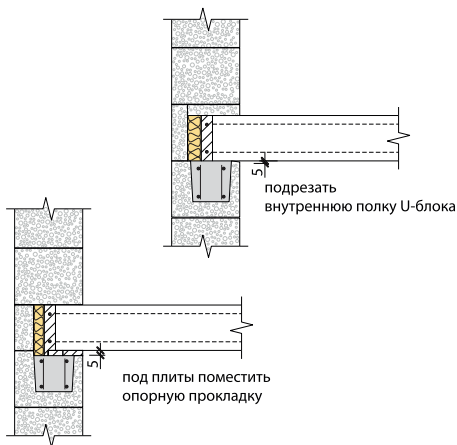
Варианты перекрытий по стенам из блоков AEROC
